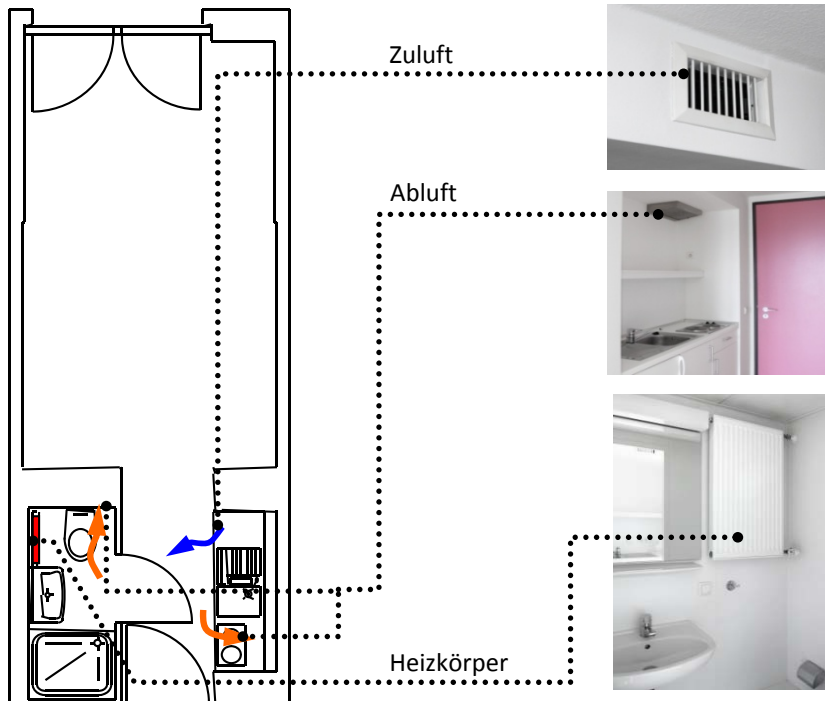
Grundriss Konzept der Heizung und Lüftung eines Einzelapartments im PH. Lediglich das Bad verfügt über einen Heizkörper. Im Zimmer wird benötigte Heizwärme über die zentrale Lüftungsanlage eingebracht. Durch die Lüftungsanlage wird dauerhaft Luft aus dem Bad und über der Küchenzeile abgesaugt, die dem zentralen Lüftungsgerät und der Wärmerückgewinnung auf dem Dach des Gebäudes zugeführt wird. Hier wird die Luft vorgewärmt und im Bedarfsfall nacherhitzt und anschließend in die Zimmer verteilt.
